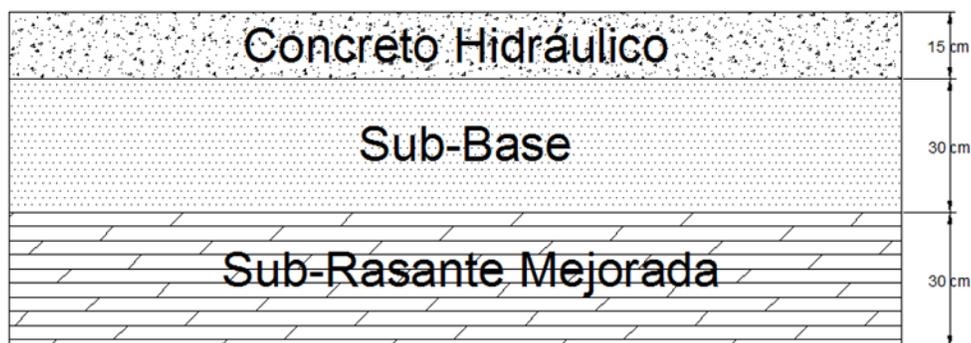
Estructura de Pavimento Rígido (Fuente Propia).
